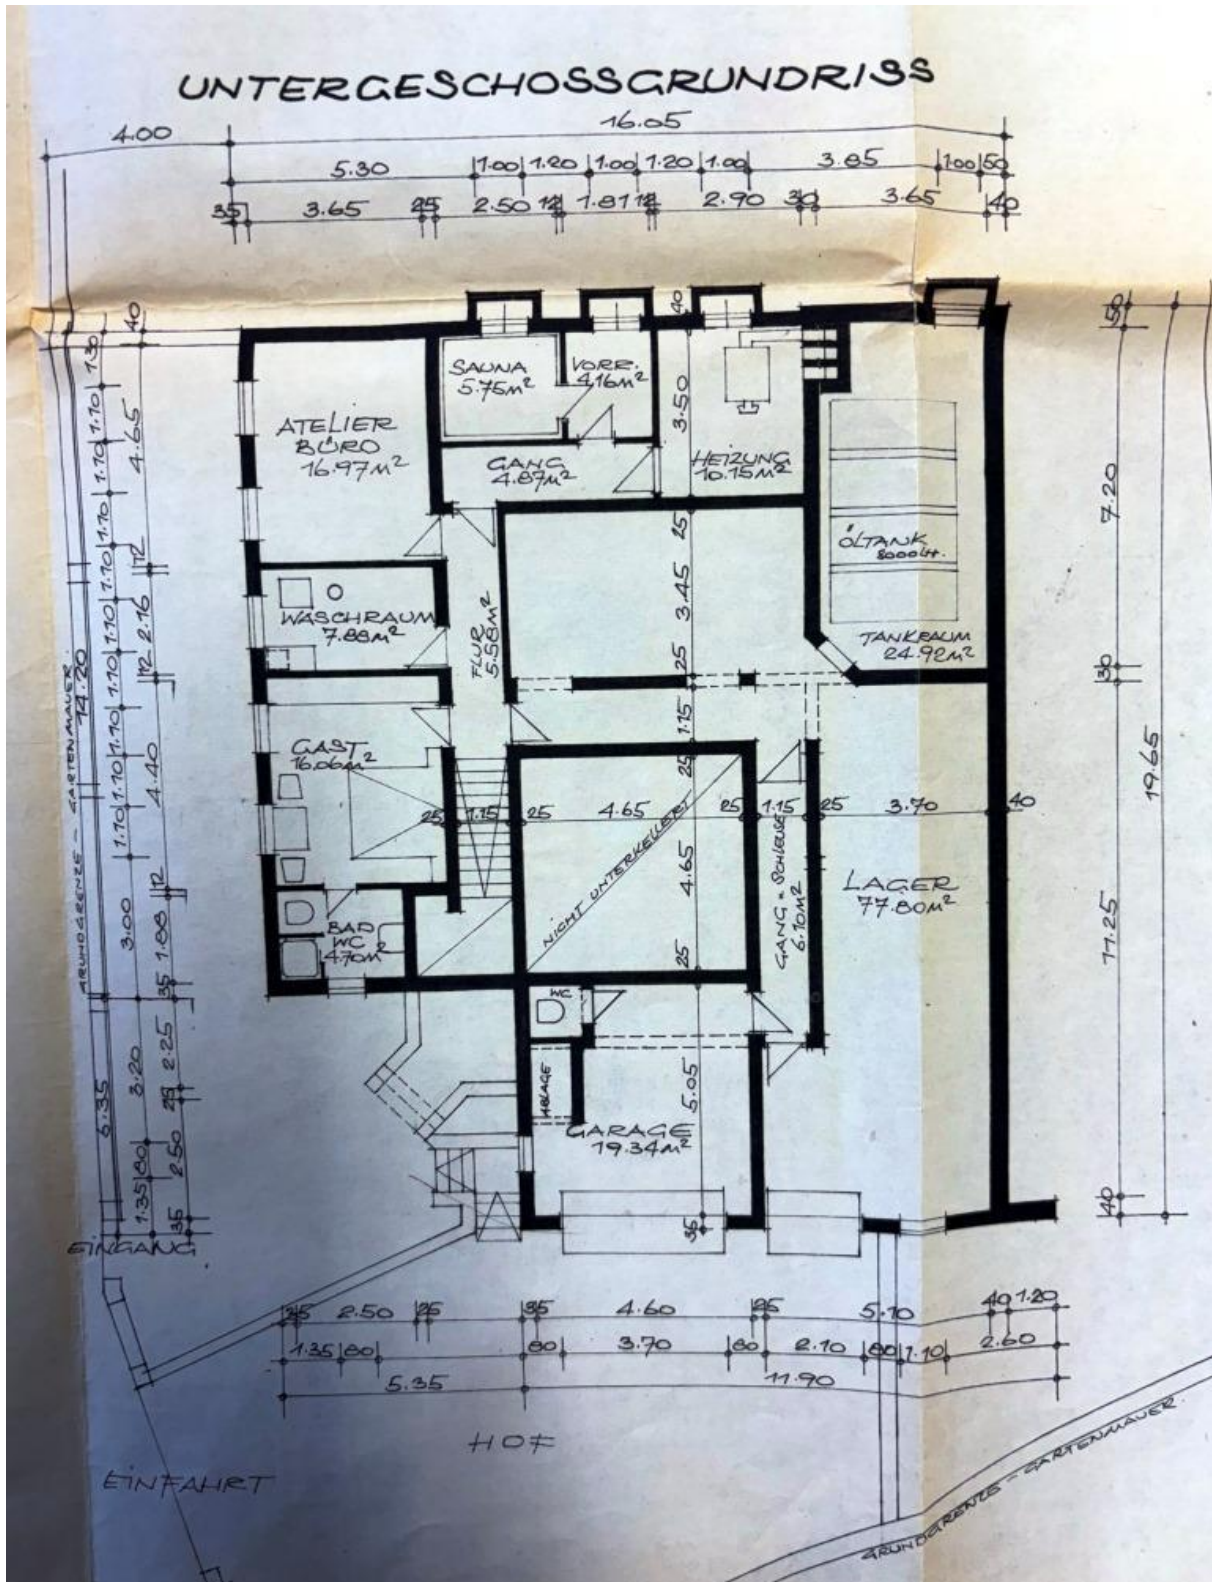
Grundriss Untergeschoss 1972
